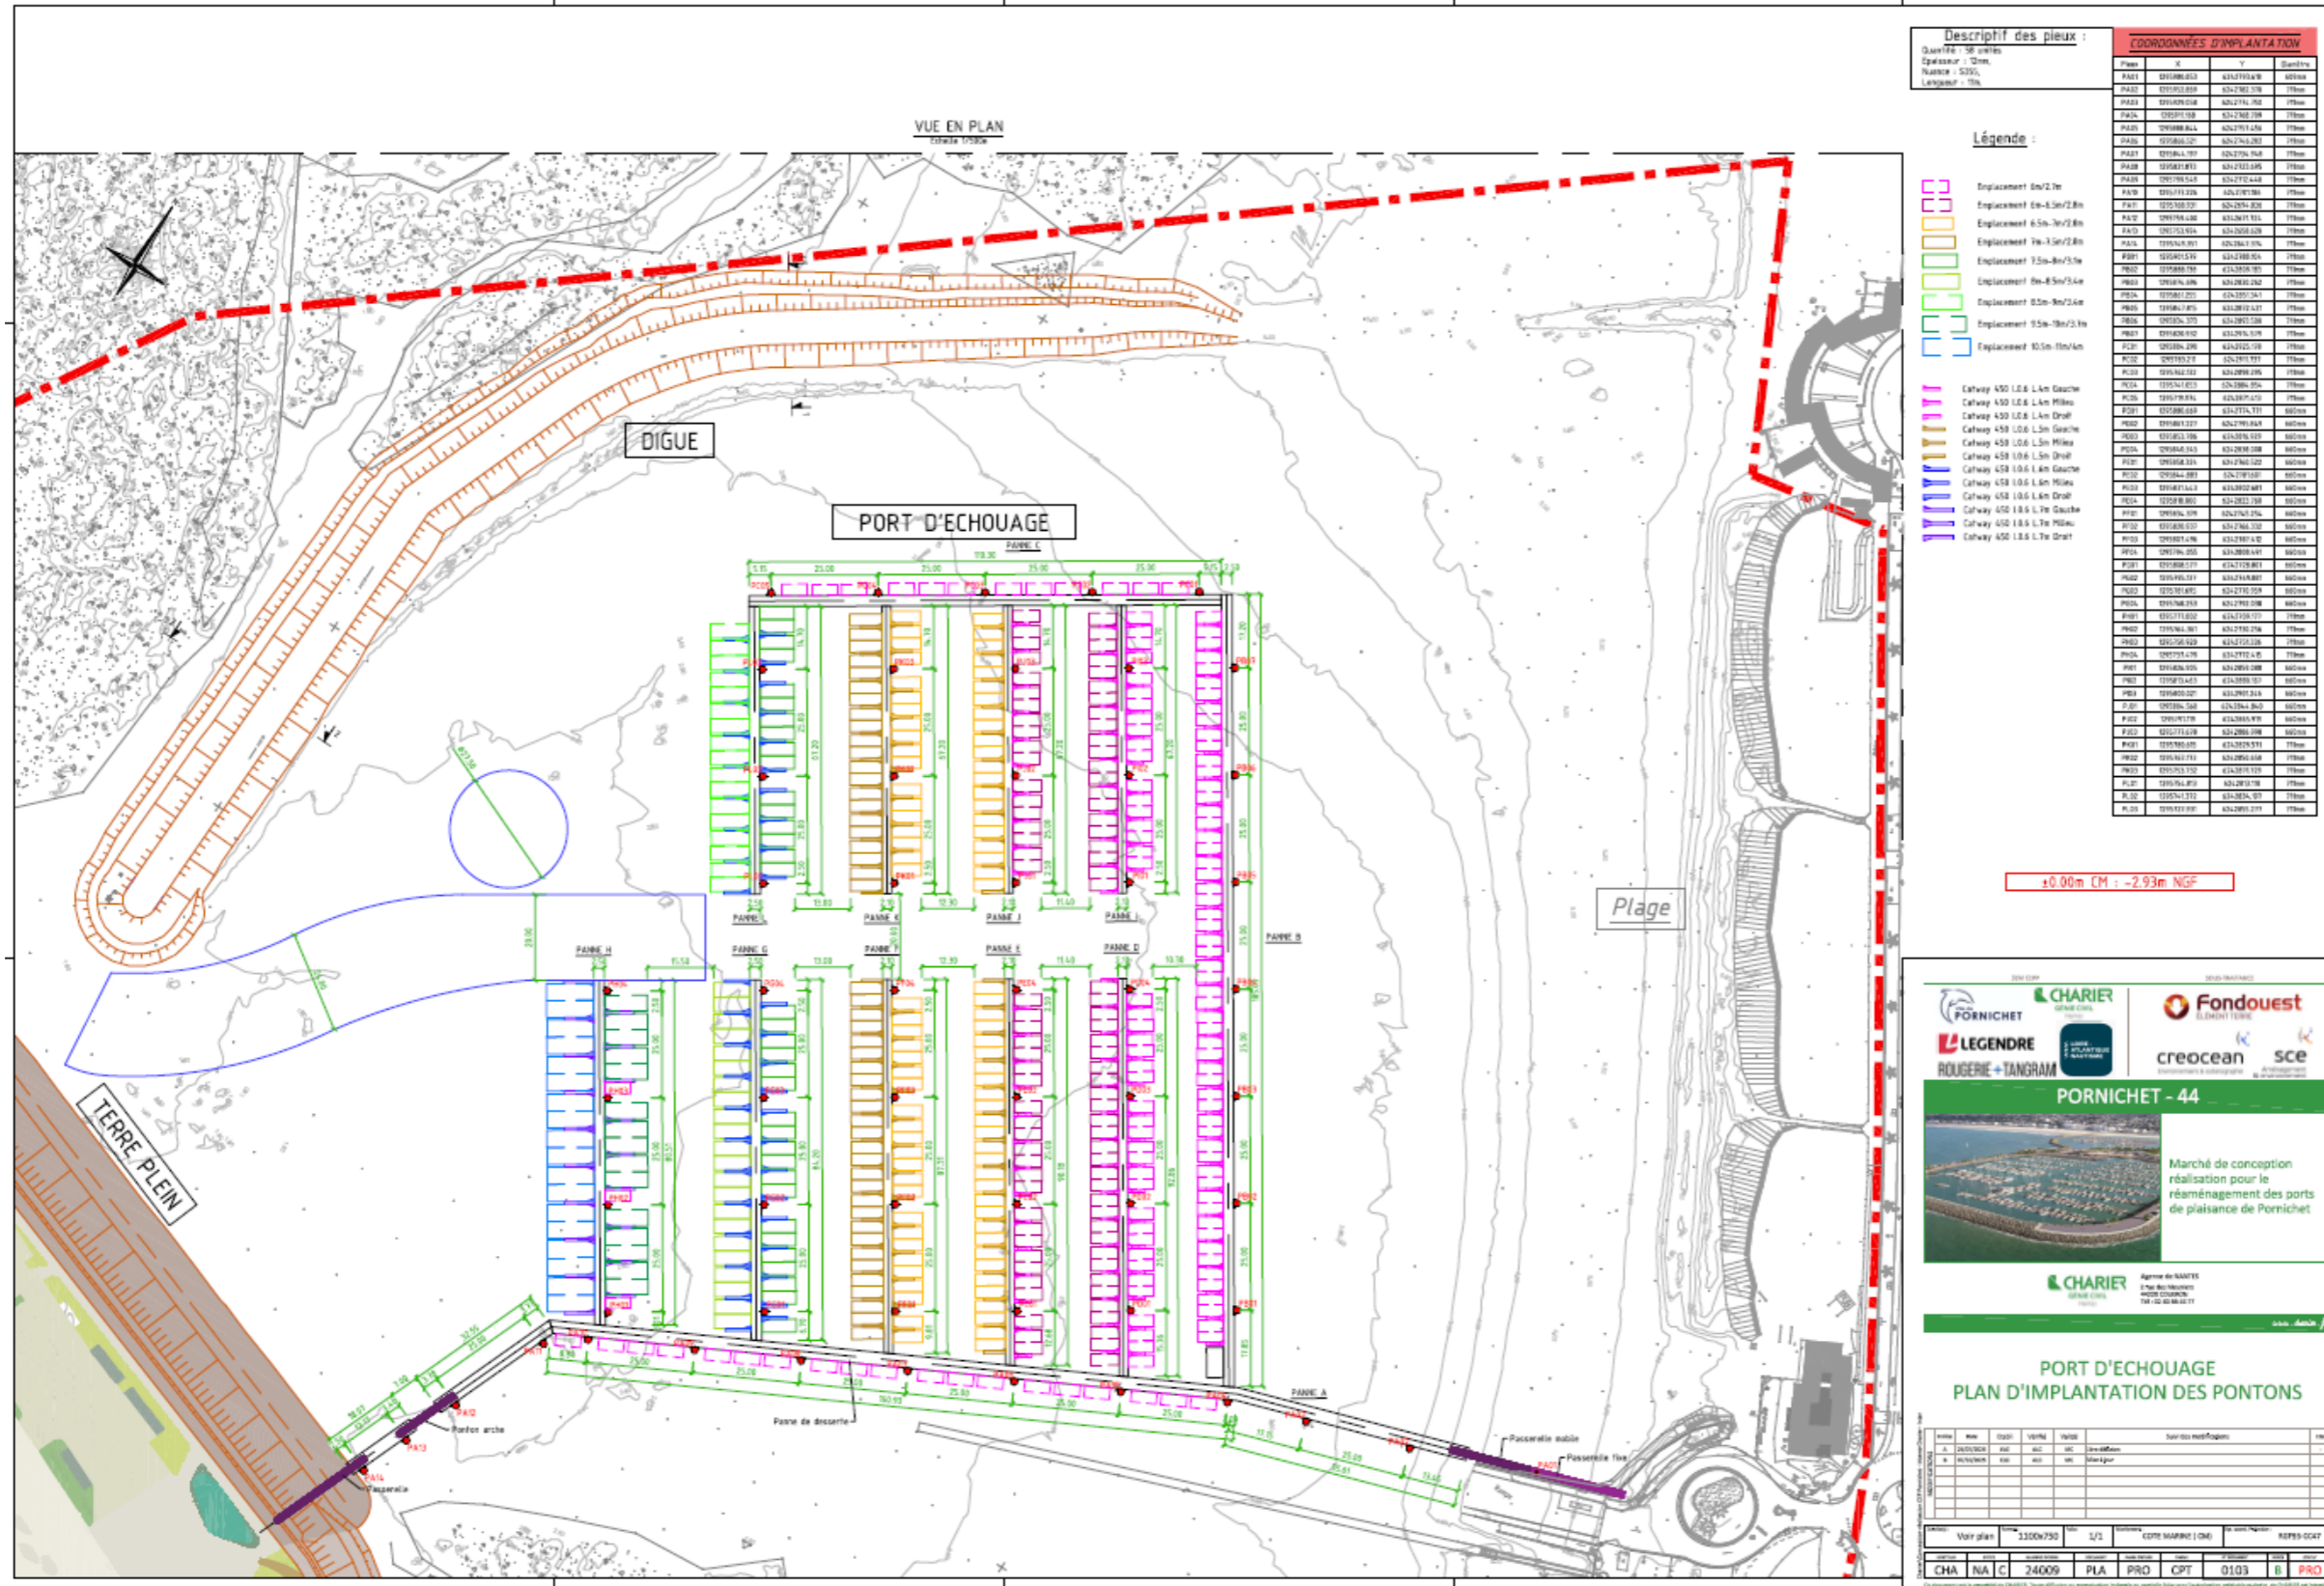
Plan d'implantation des pontons et passerelles dans le bassin d'échouage
